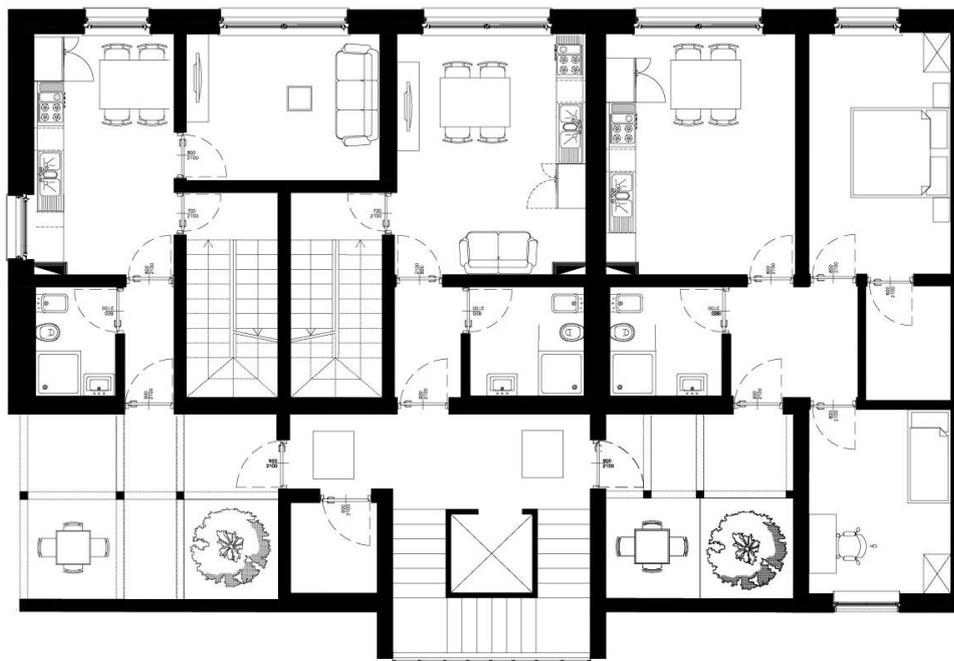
Pianta piano primo sopraelevazione edificio Tipologia B
